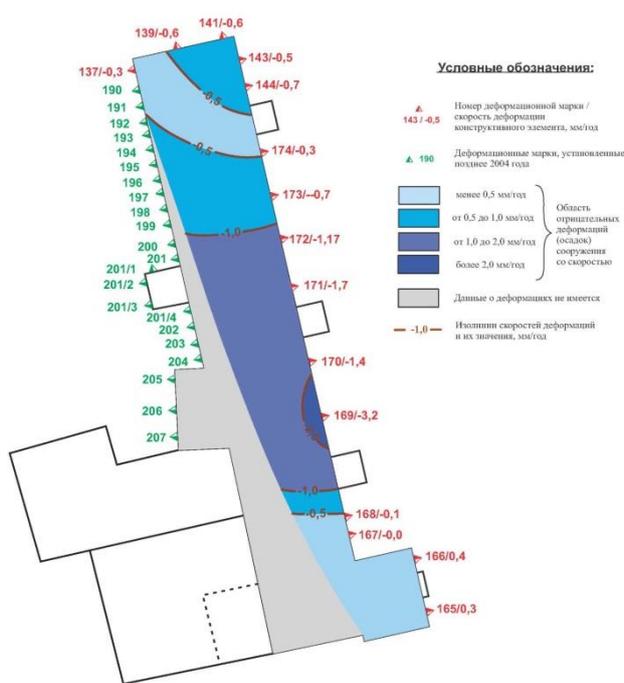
Схема деформаций конструктивных элементов Казначейского корпуса до закрепления основания
